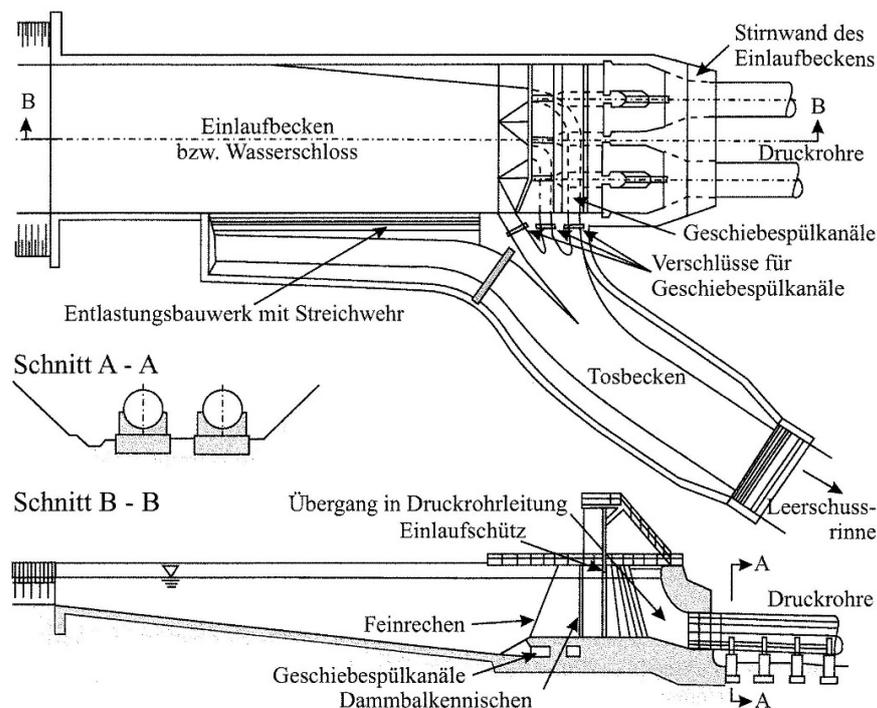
Prise d'eau avec bassin de retenue au point de transition entre la conduite gravitaire et la conduite forcée [8]
